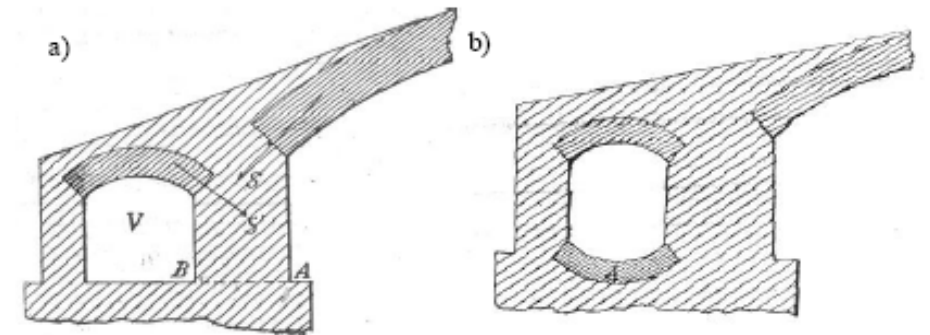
Vani dentro le spalle per diminuire (a) il volume; (b) il carico in fondazione (Baggi, 1926)
